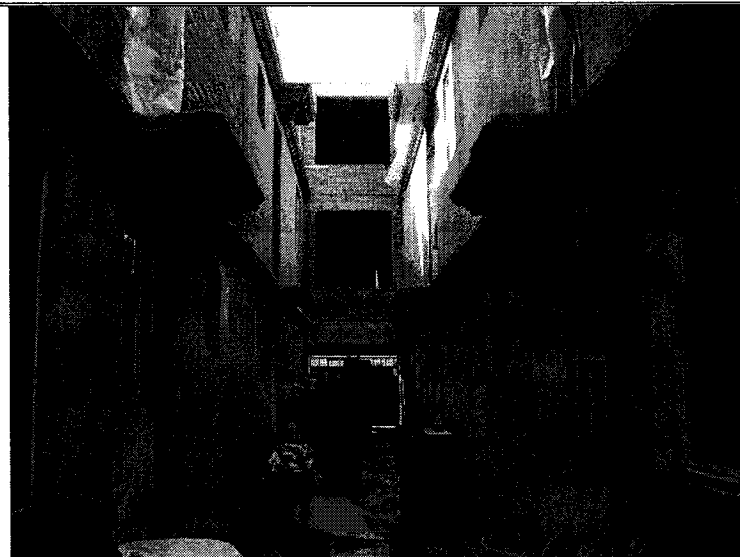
Levantamiento de Muros de 3er. Nivel.
